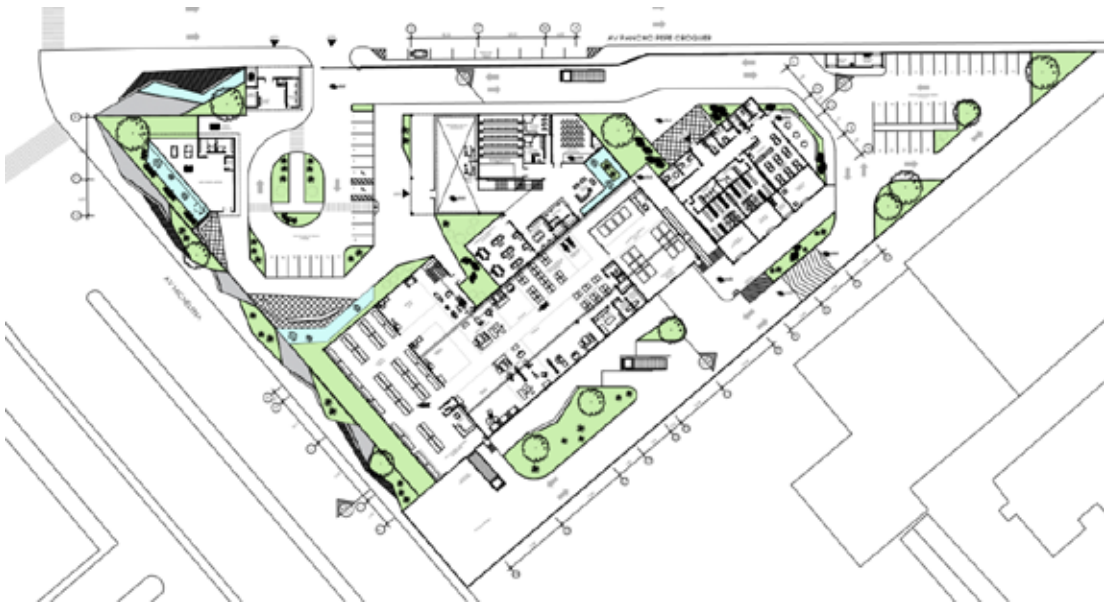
Planta Baja. Autora: Nathalie Colmenares. (2019)
